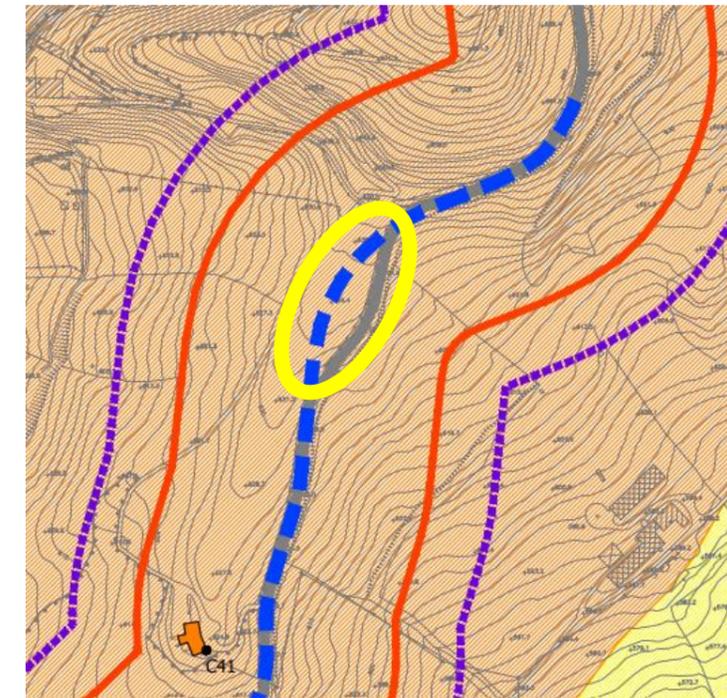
Stralcio PCCA – Cantiere CO 9
